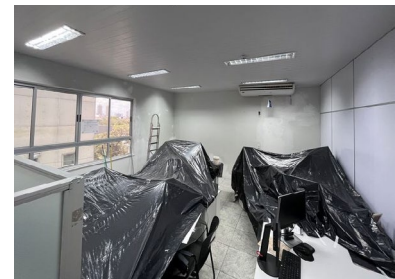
Pintura da Secretaria de Administração – 5º andar Ed. Sede
